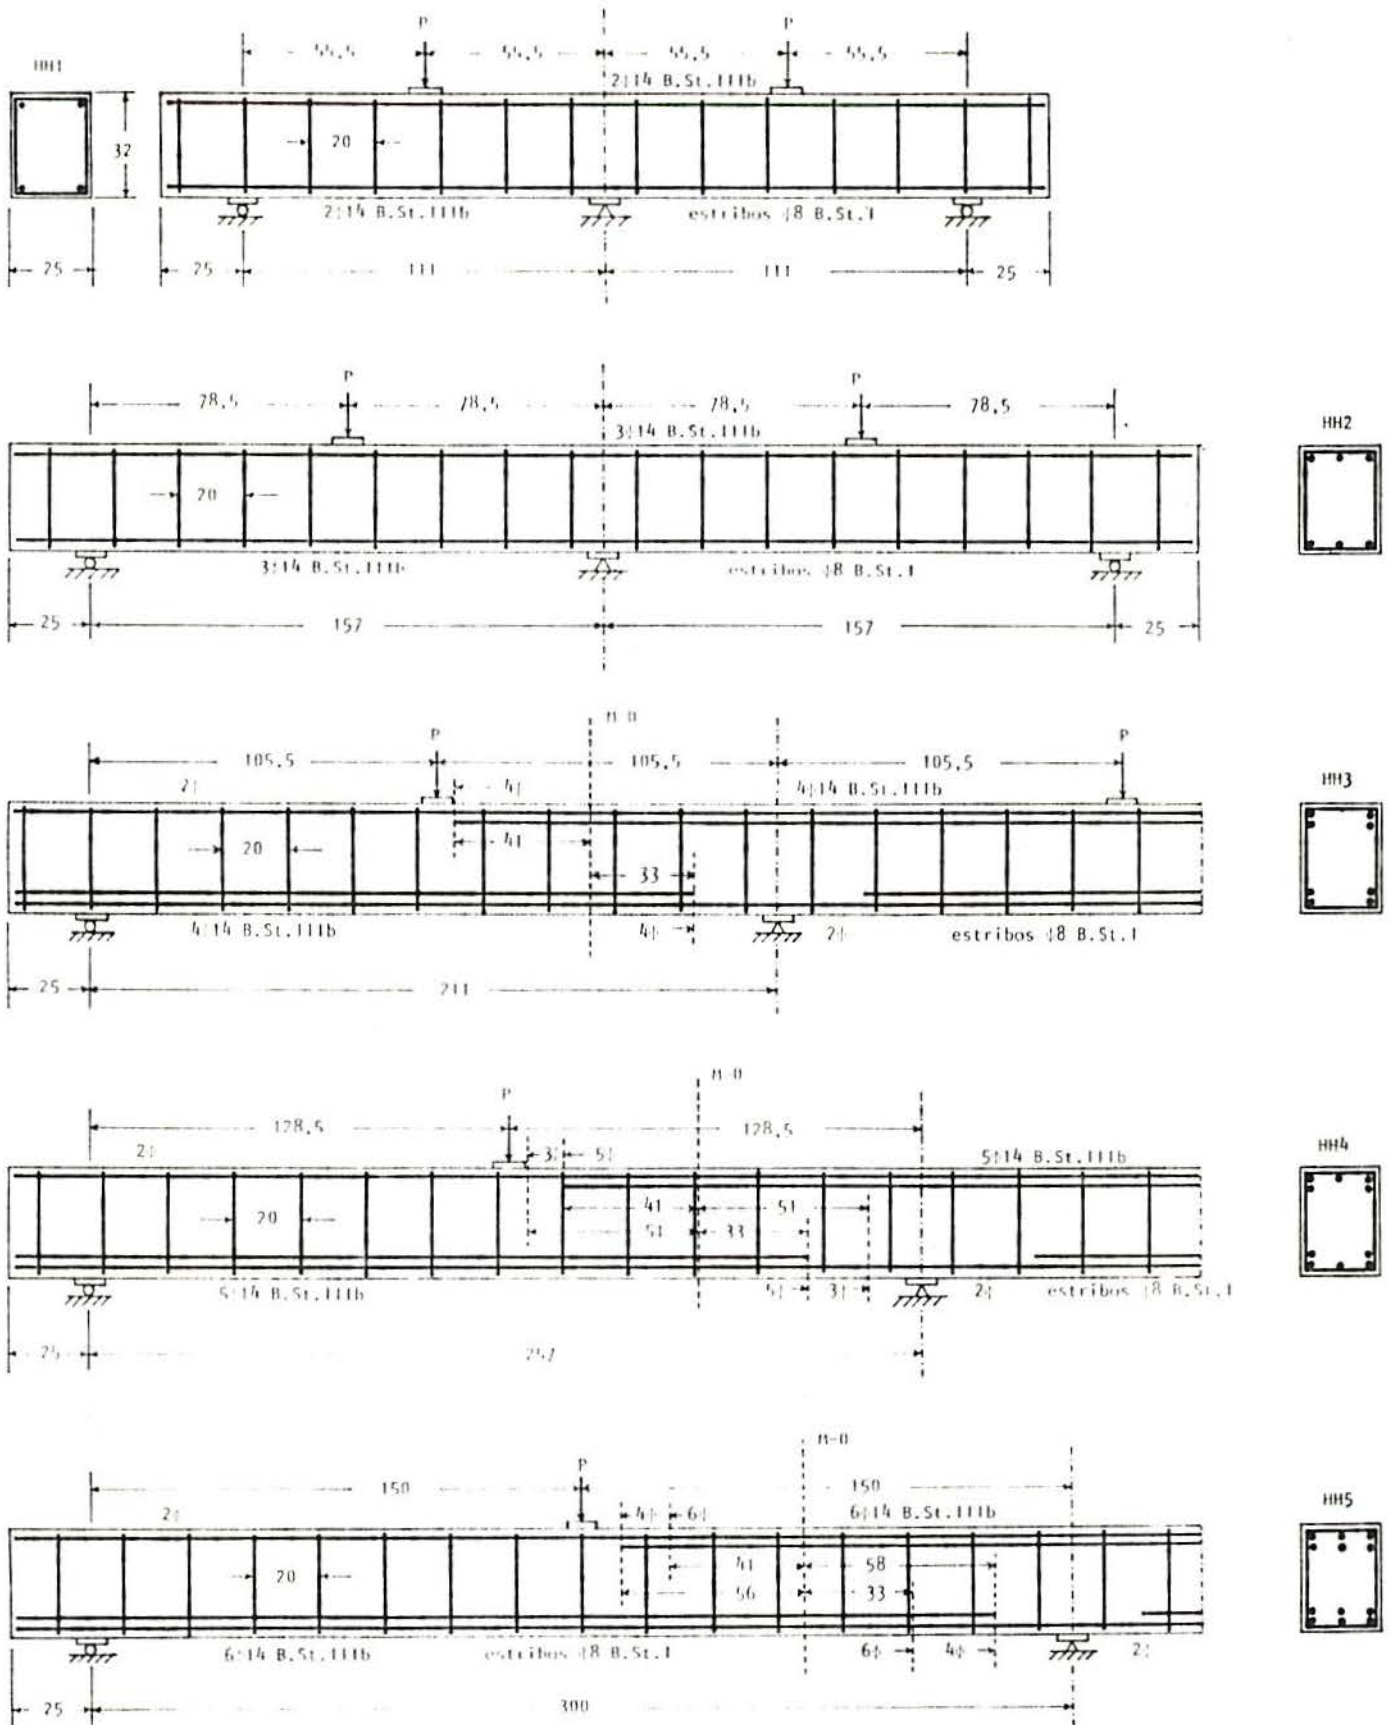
Detalhamento das cinco vigas contínuas
